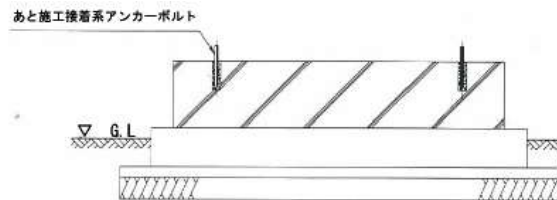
基礎施工例 資料提供) 森松工業 (株)
